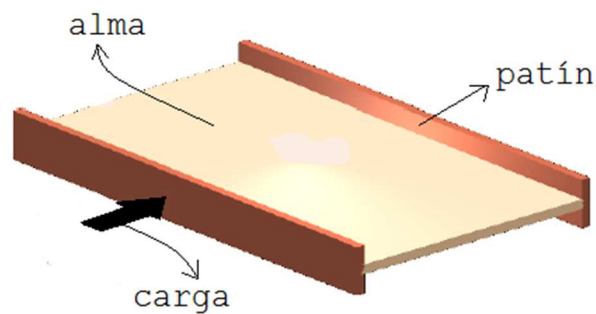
Analogía de viga para el planteamiento de la rigidez en el plano del sistema piso
